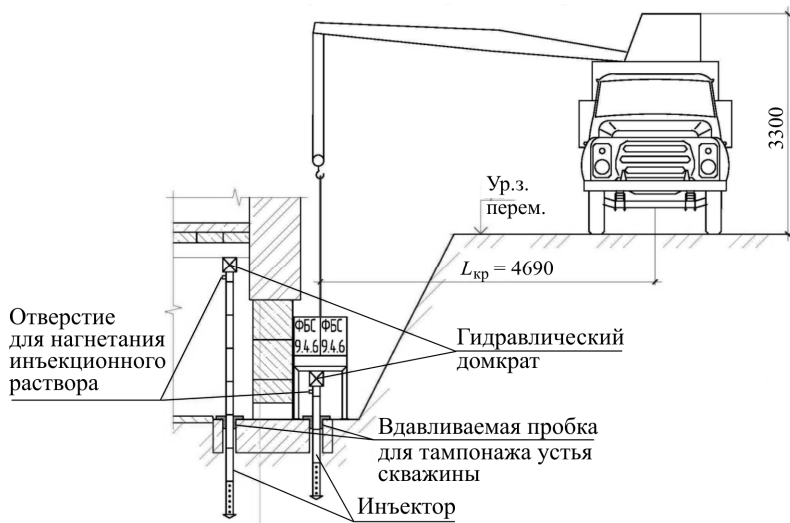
Технология производства работ по усилению фундамента иньекционными сваями на третьем этапе
